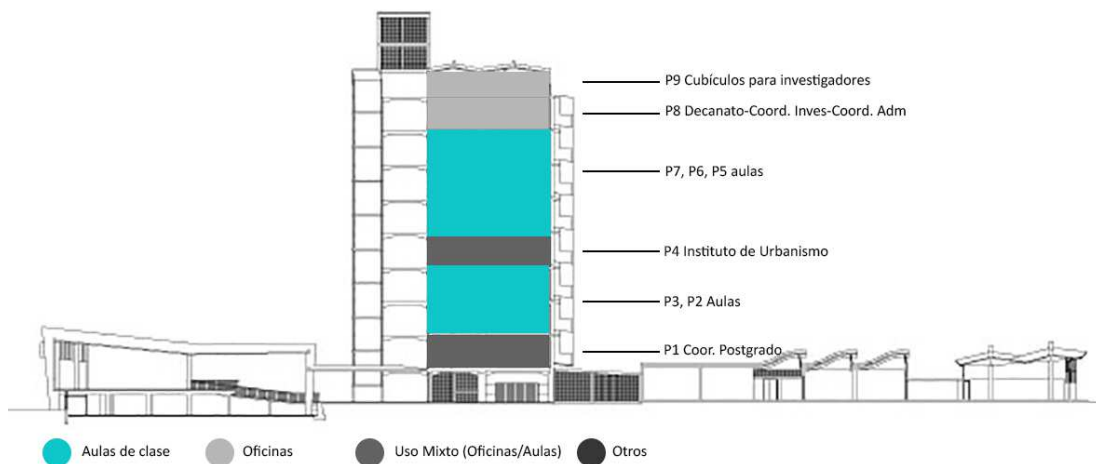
Distribución de la ocupación actual de la planta baja del conjunto de la FAU
